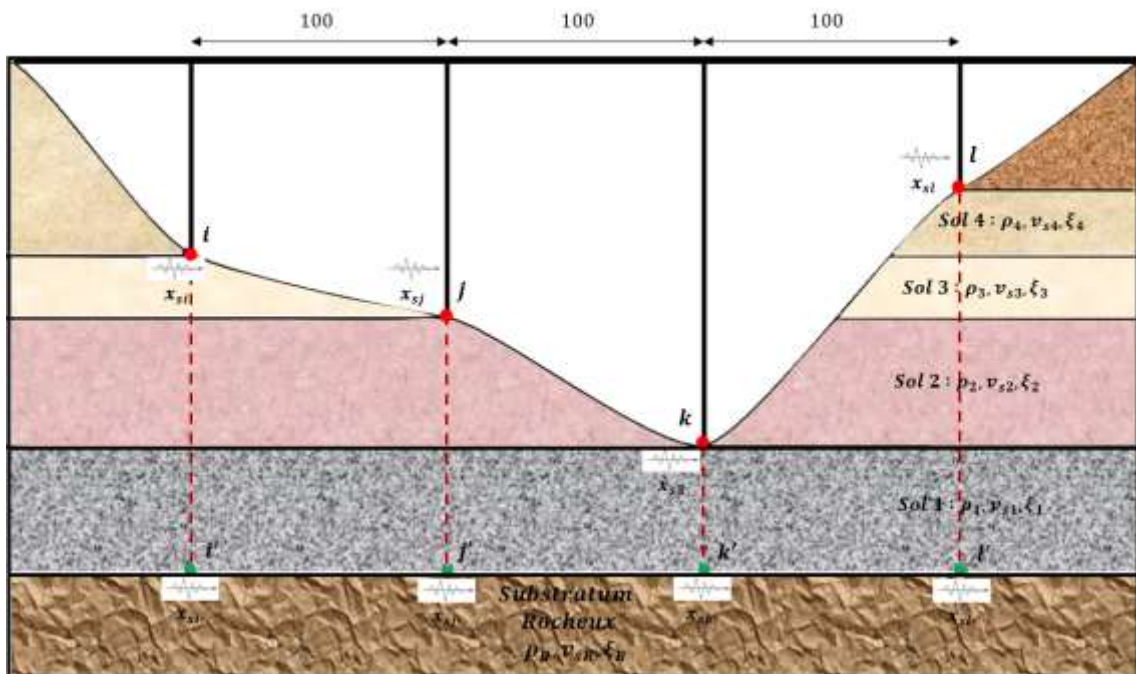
98. Schéma de d'un pont supporté par quatre piles implanté sur un site multicouche.
